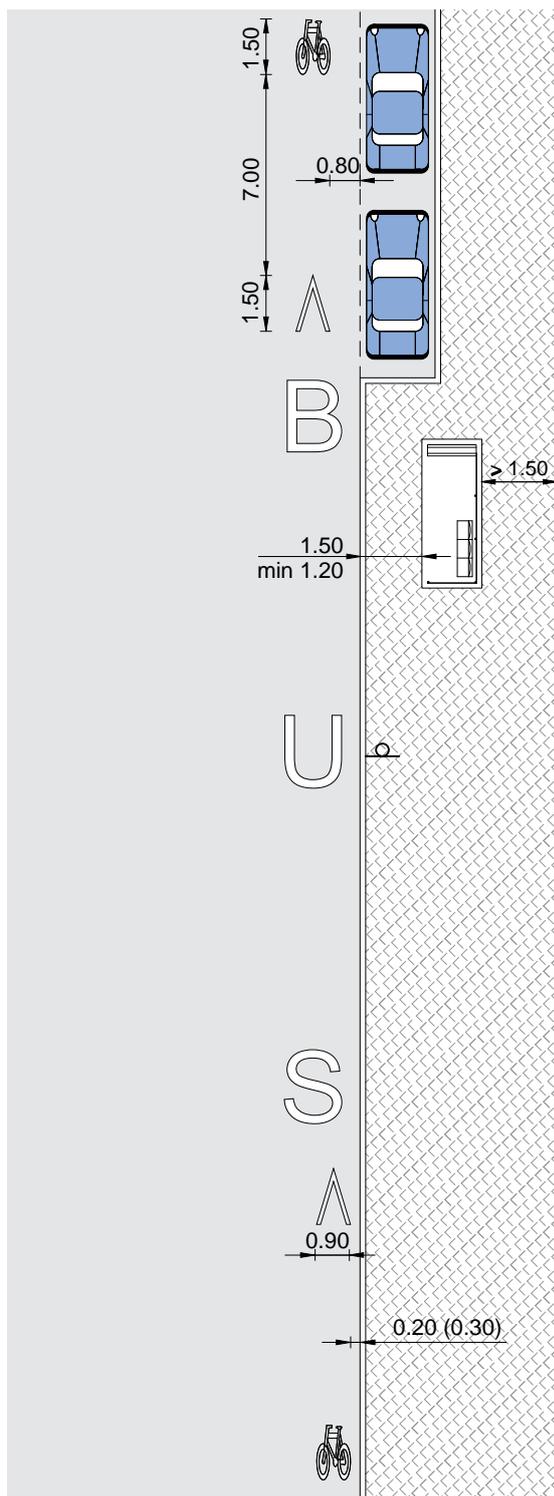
Piste cyclable marquée et arrêt sur la chaussée
